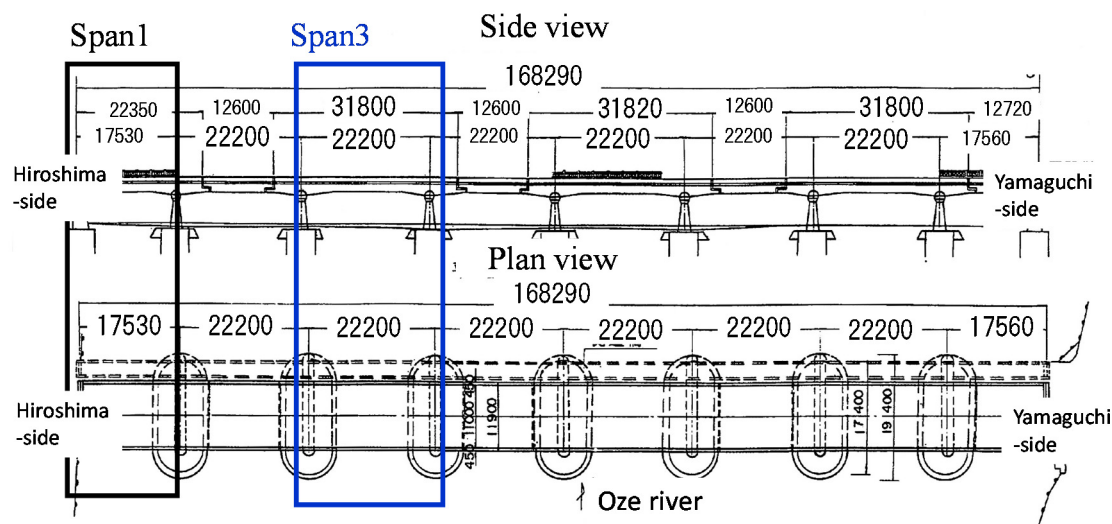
対象橋梁(SK橋)の側面図および平面図(撤去前)と調査区間
